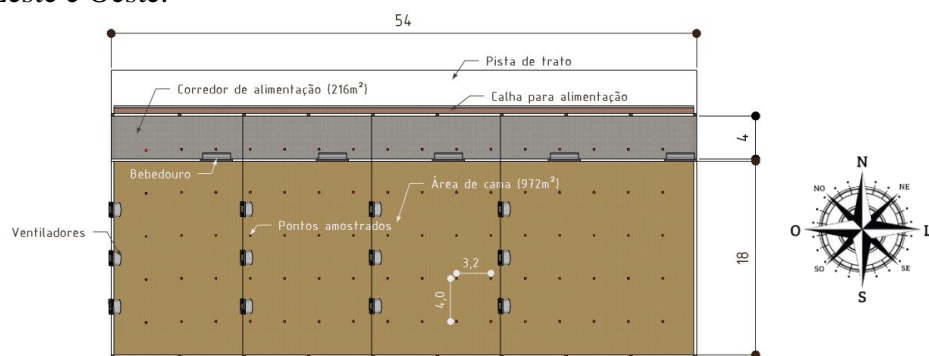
Layout da instalação com dimensões em metros e disposição dos pontos mensurados.
